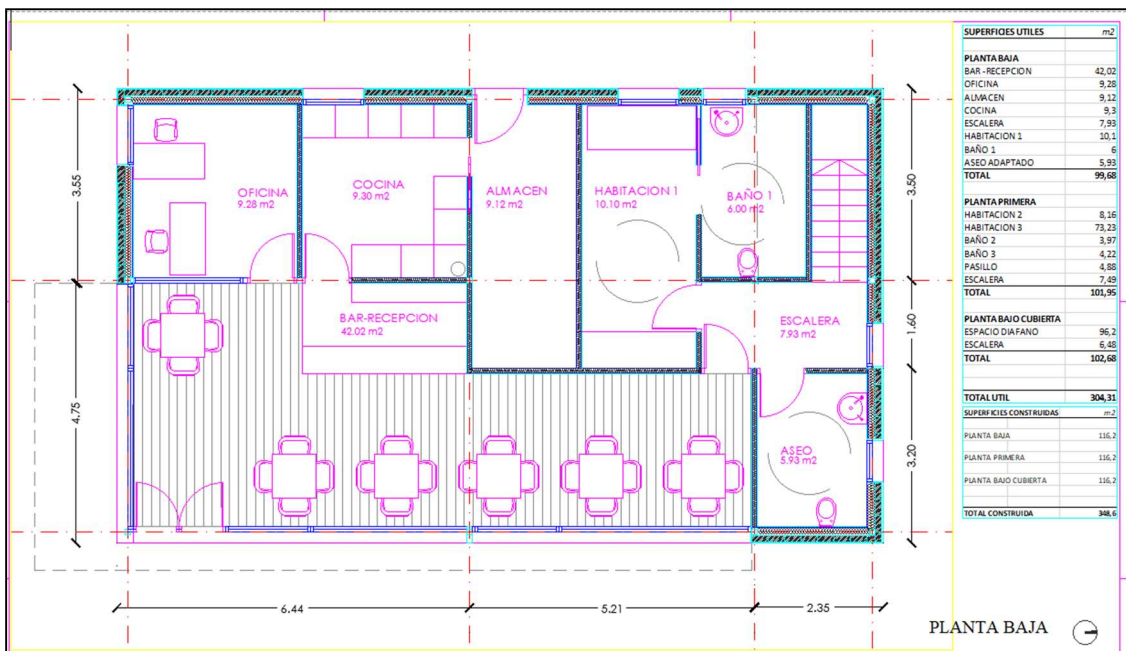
Plano de la planta baja. (Fuente: Proyecto básico y en ejecución Albergue en Sabayés, Nueno (Huesca) abril 2017 (Gavin, 2017))
